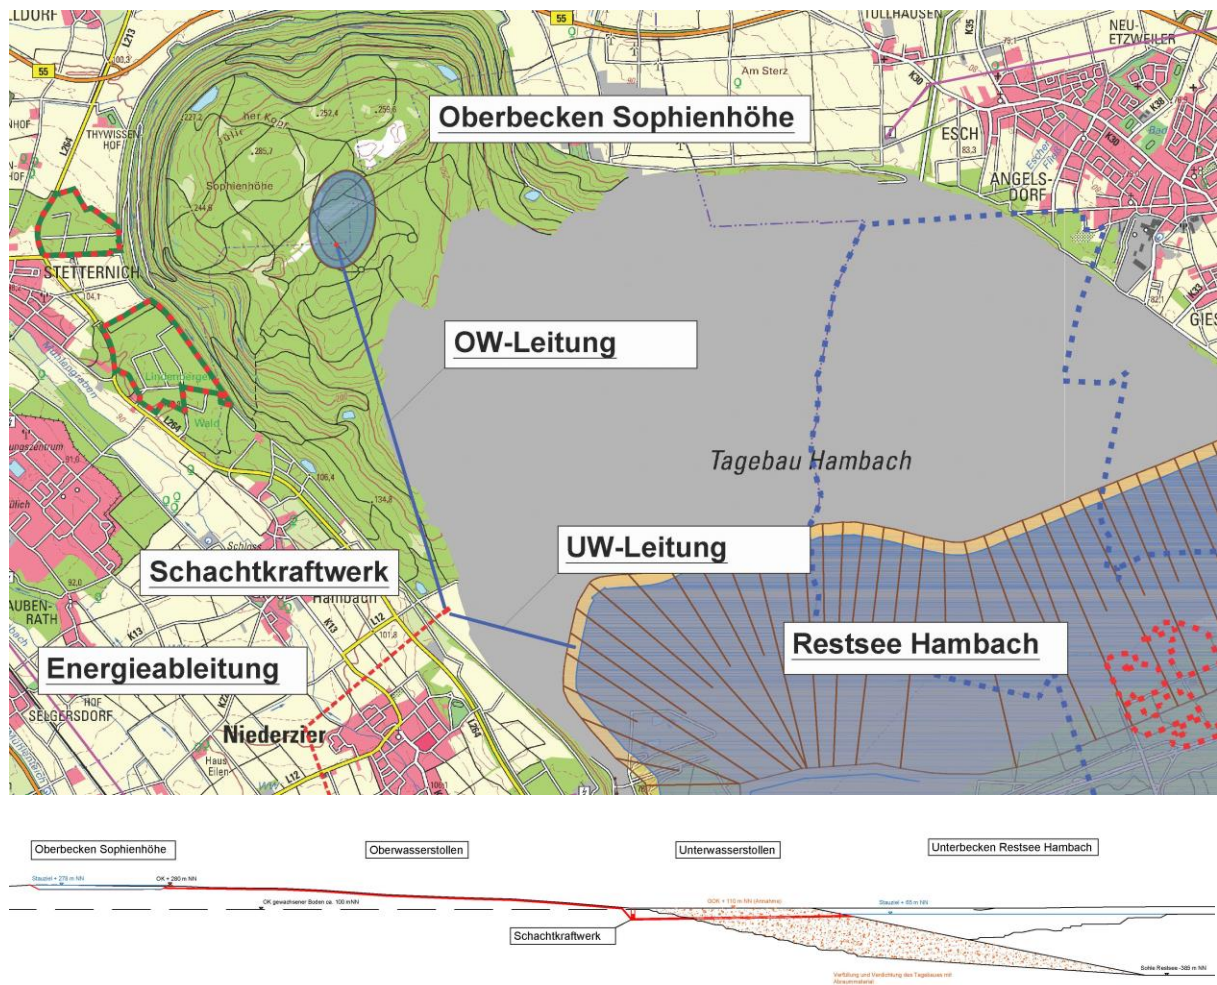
Lageplan und Längsschnitt für Alternative „Schachtkraftwerk“ in PSW-Variante 2.4
